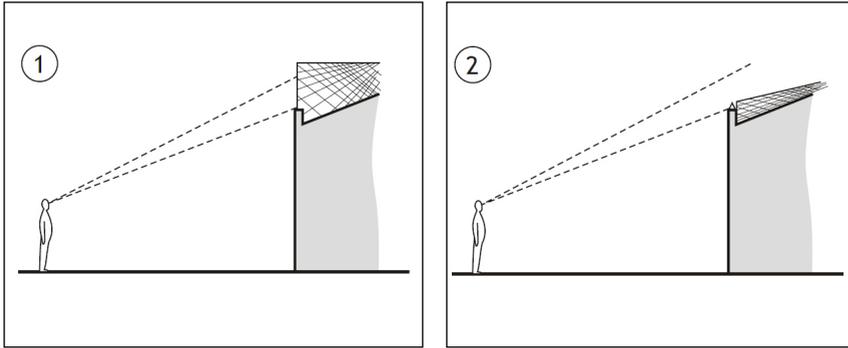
Nel primo esempio (1) la rete è stata posizionata dalla sommità del parapetto rendendola chiaramente visibile dalla strada. Nel secondo esempio (2) la rete parte da dietro il parapetto e puntali o fili ballerini sono stati utilizzati sulla parte superiore del parapetto per evitare che i gabbiani vi si posino (tratta da Gloucester City Council, 2005).
